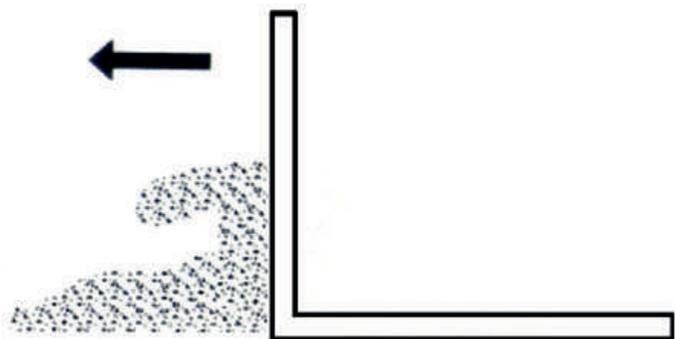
Направление перемещения виброрейки по обрабатываемой поверхности
